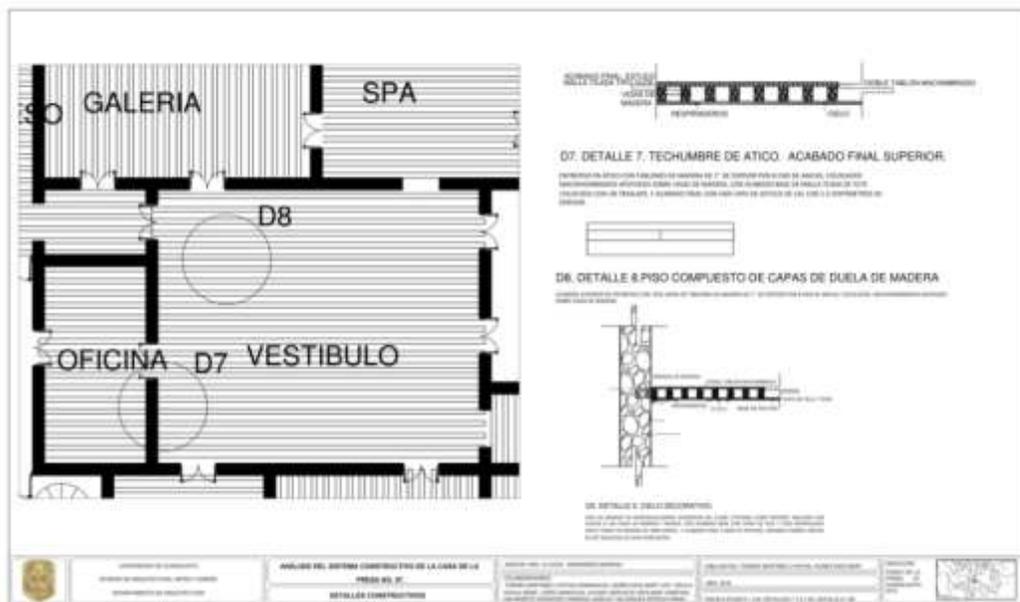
Plano donde se muestra la alineación de la vigería y los detalles constructivos.
